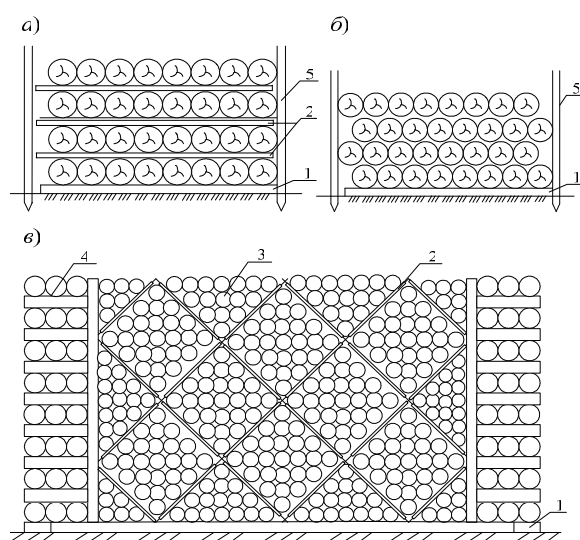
Типы штабелей для укладки круглого леса:
